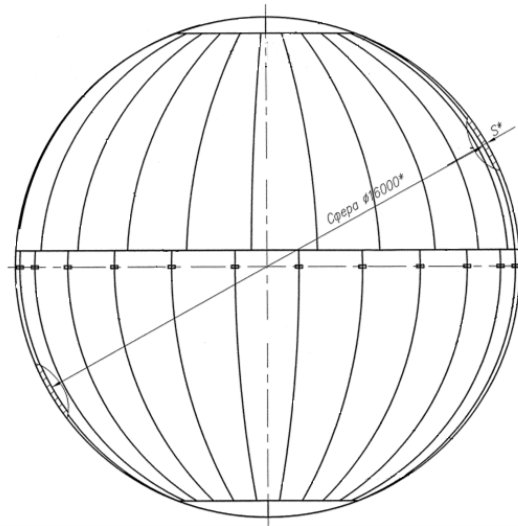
Схема раскроя корпуса шарового резервуара объемом 2000 м^3
